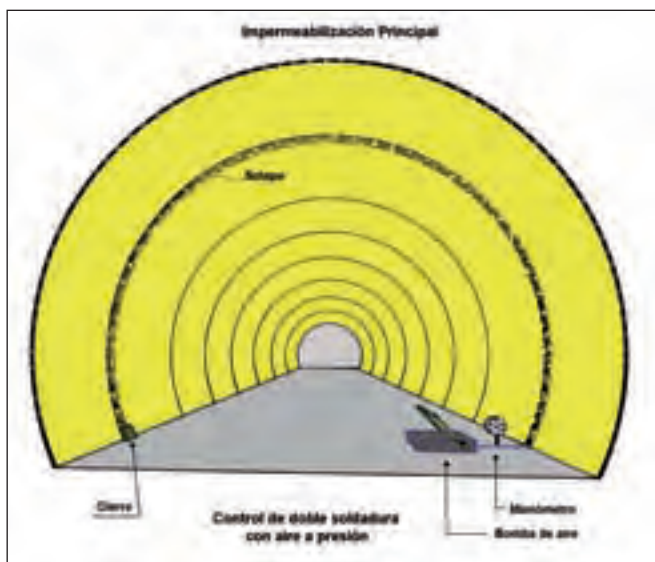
Esquema de control de presión de una soldadura doble con canal
